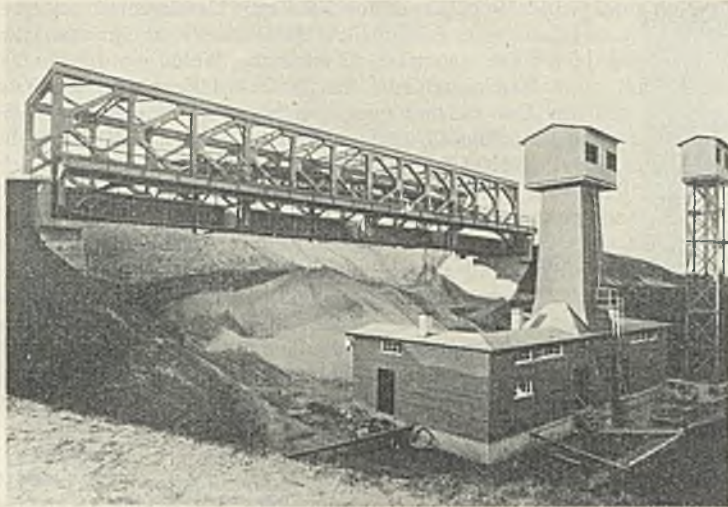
Neue Sandentladebrücke Delbrückschacht mit Spülschacht.
